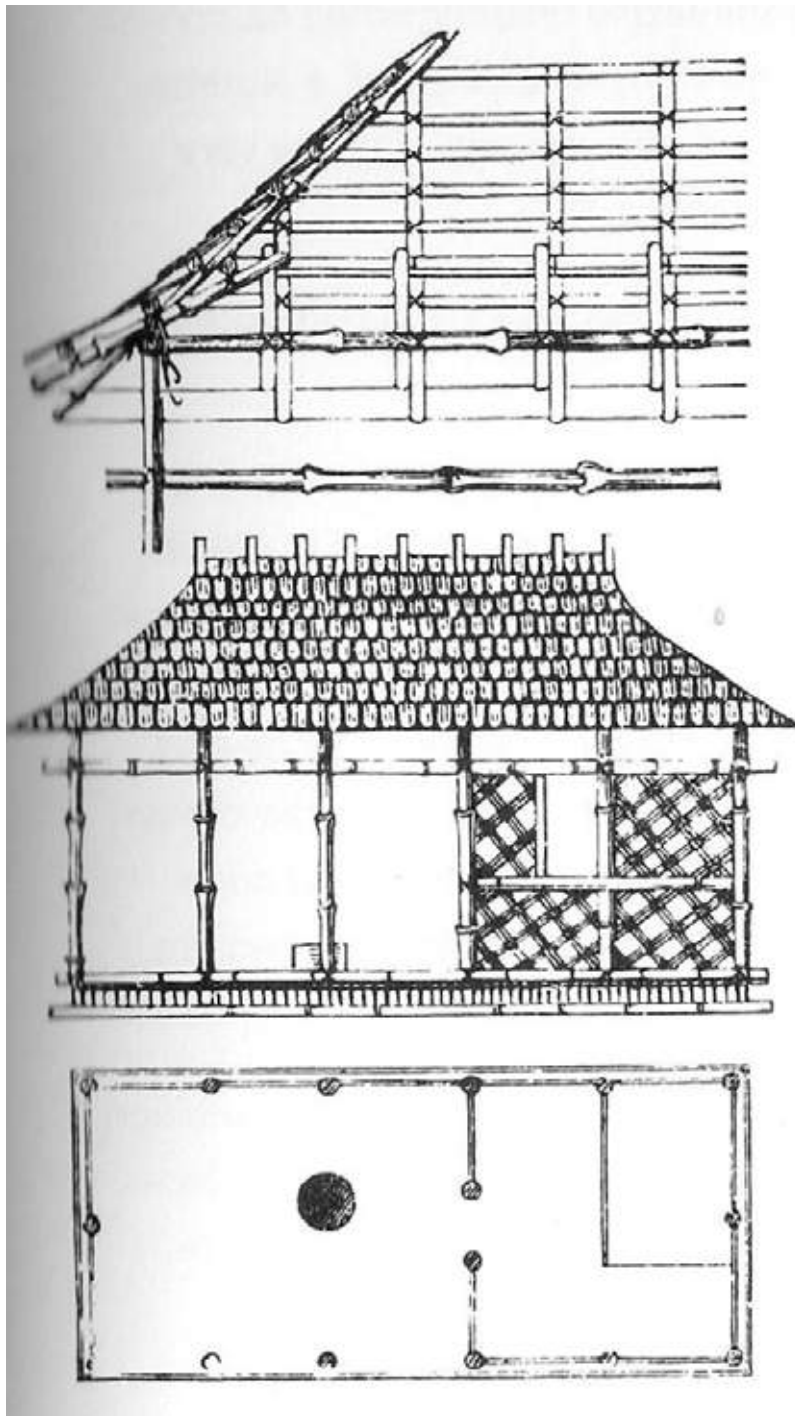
Gottfried Semper: Ilustração de *Die vier Element der Baukunst* de 1851. Quatro elementos tectónicos essenciais – fundação e pavimento; estrutura e cobertura; paredes; lareira ou fogo – correspondem a quatro procedimentos construtivos básicos: alvenaria, carpintaria, tecelagem e olaria (Frampton, 1995, p. 85).
